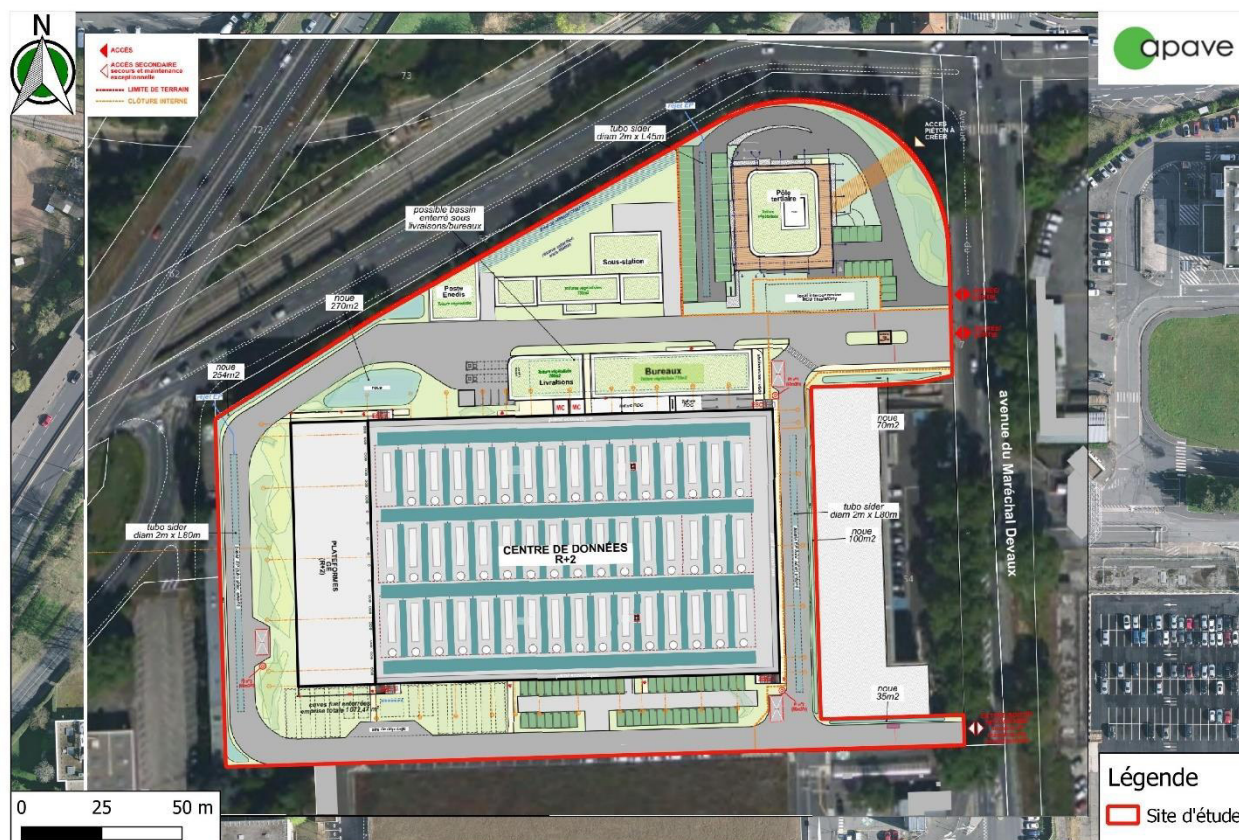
Plan de masse projet 2025 (Source : Hines)
